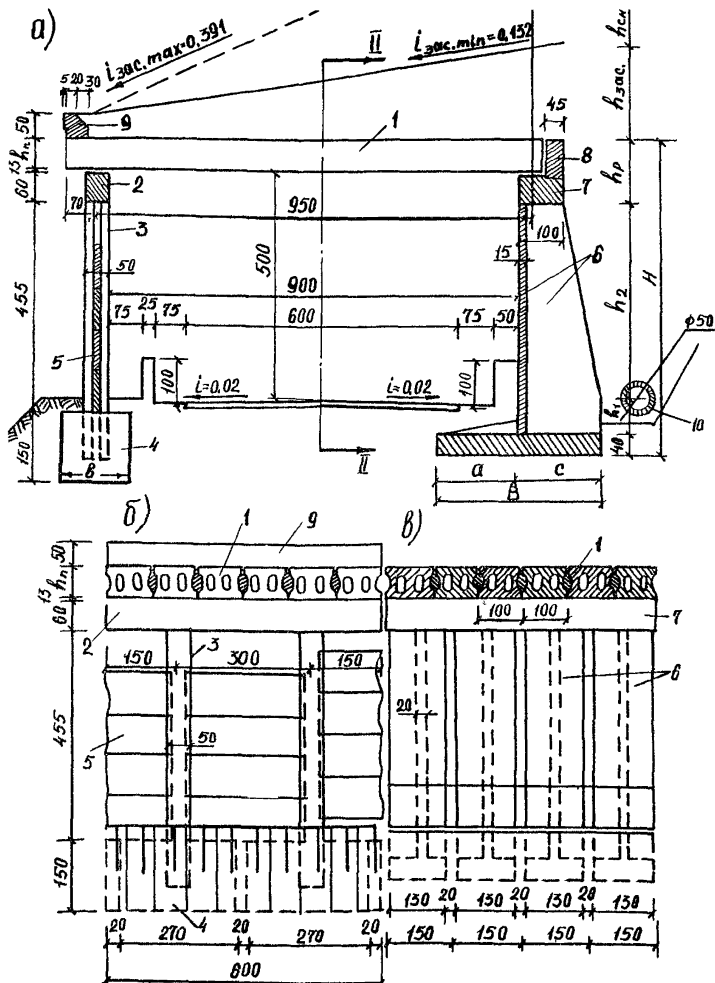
Галерея с одноярусными пустотными плитами перекрытия и угловой контрольной верхней стеной для дорог IУ-У категорий:
